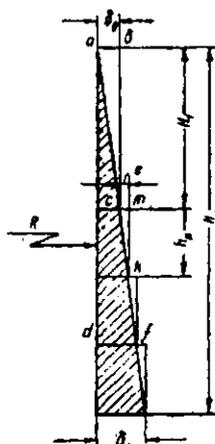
Резервуары с переменной толщиной стенки корпуса
